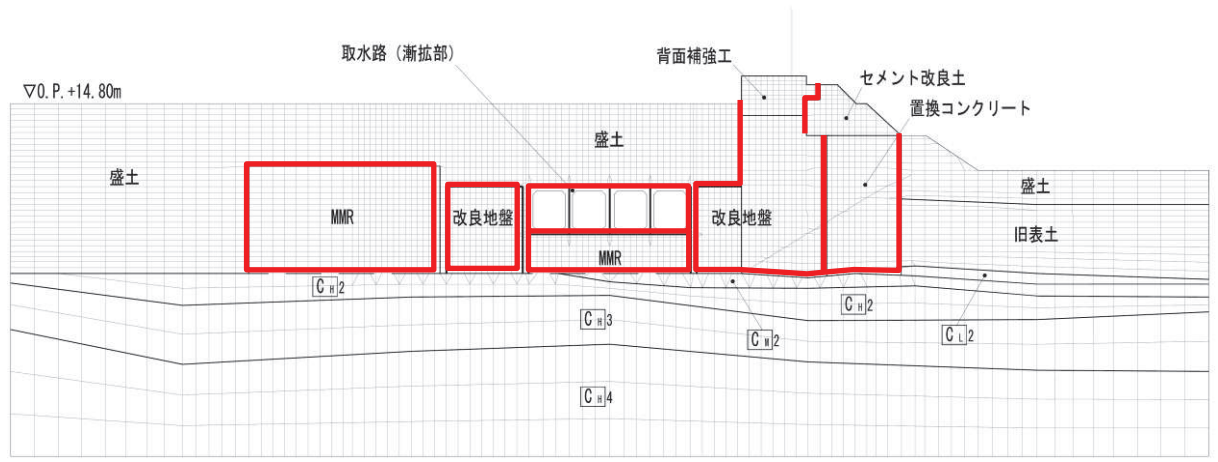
取水路 (漸拡部) の断面図 (A-A 断面)
